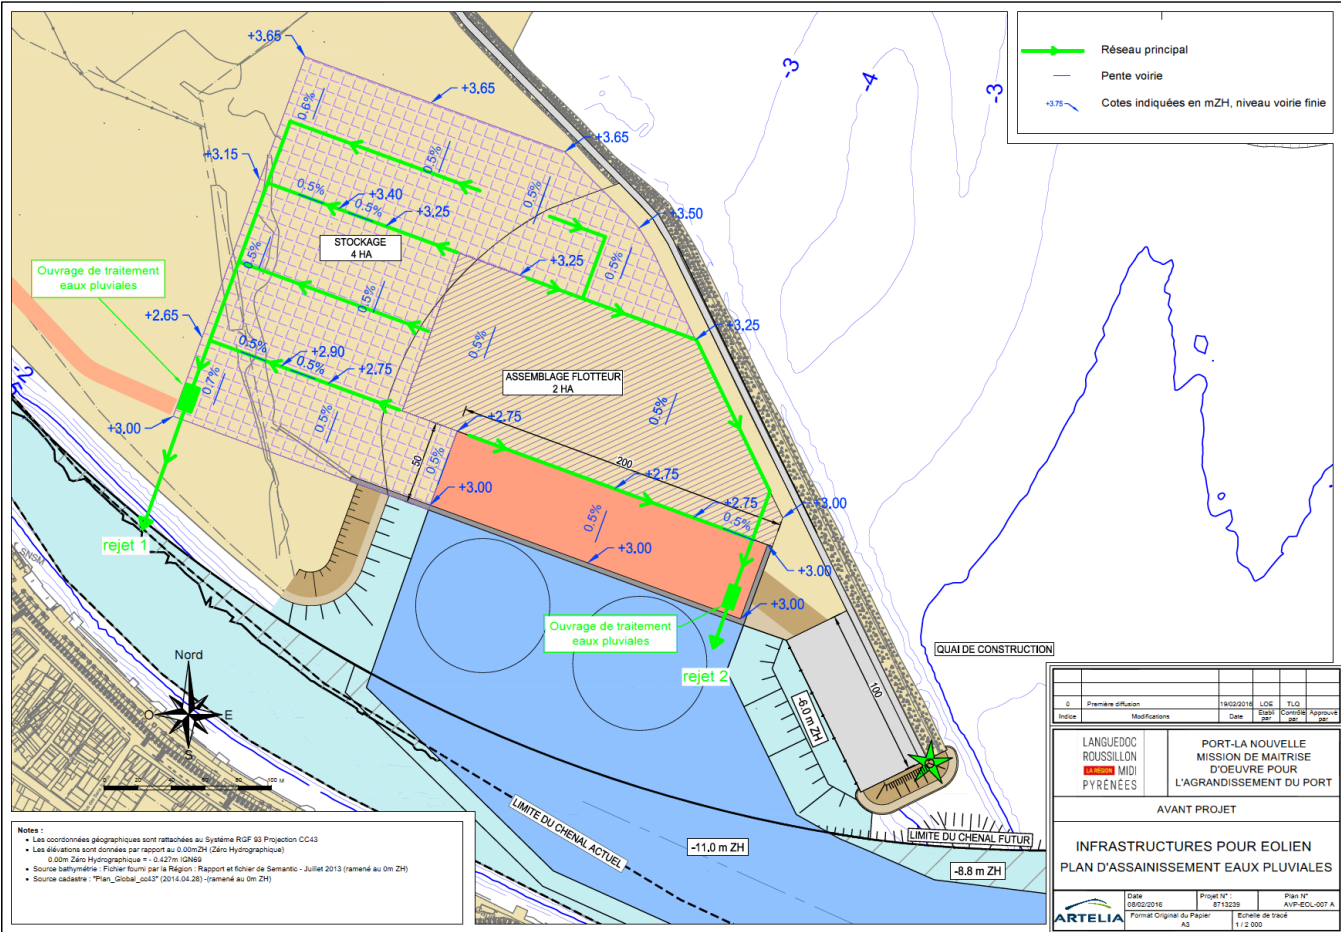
Plan d'assainissement des EP (Zone éolienne)
